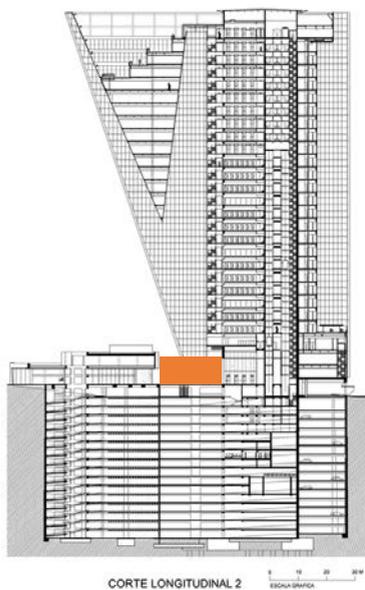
Corte Longitudinal. Imagen: Archivo TGL
